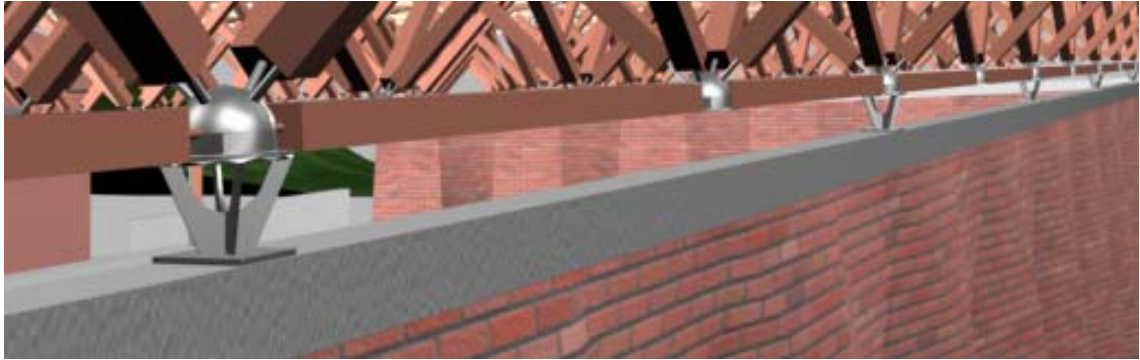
Detalle de apoyo en coronación de muro
